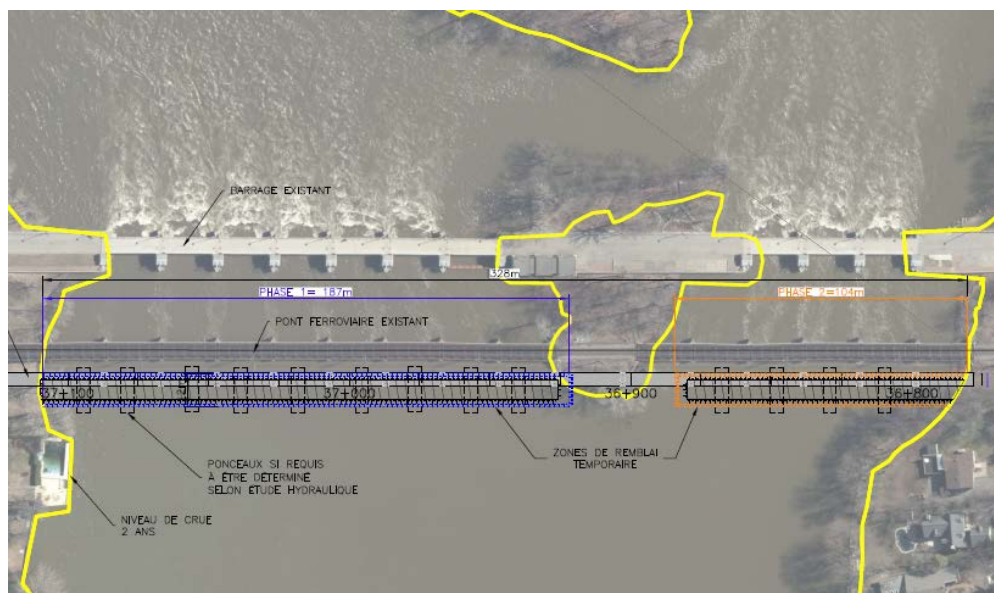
Ouvrage d'art – Modifications prévues au pont des Mille-Îles
